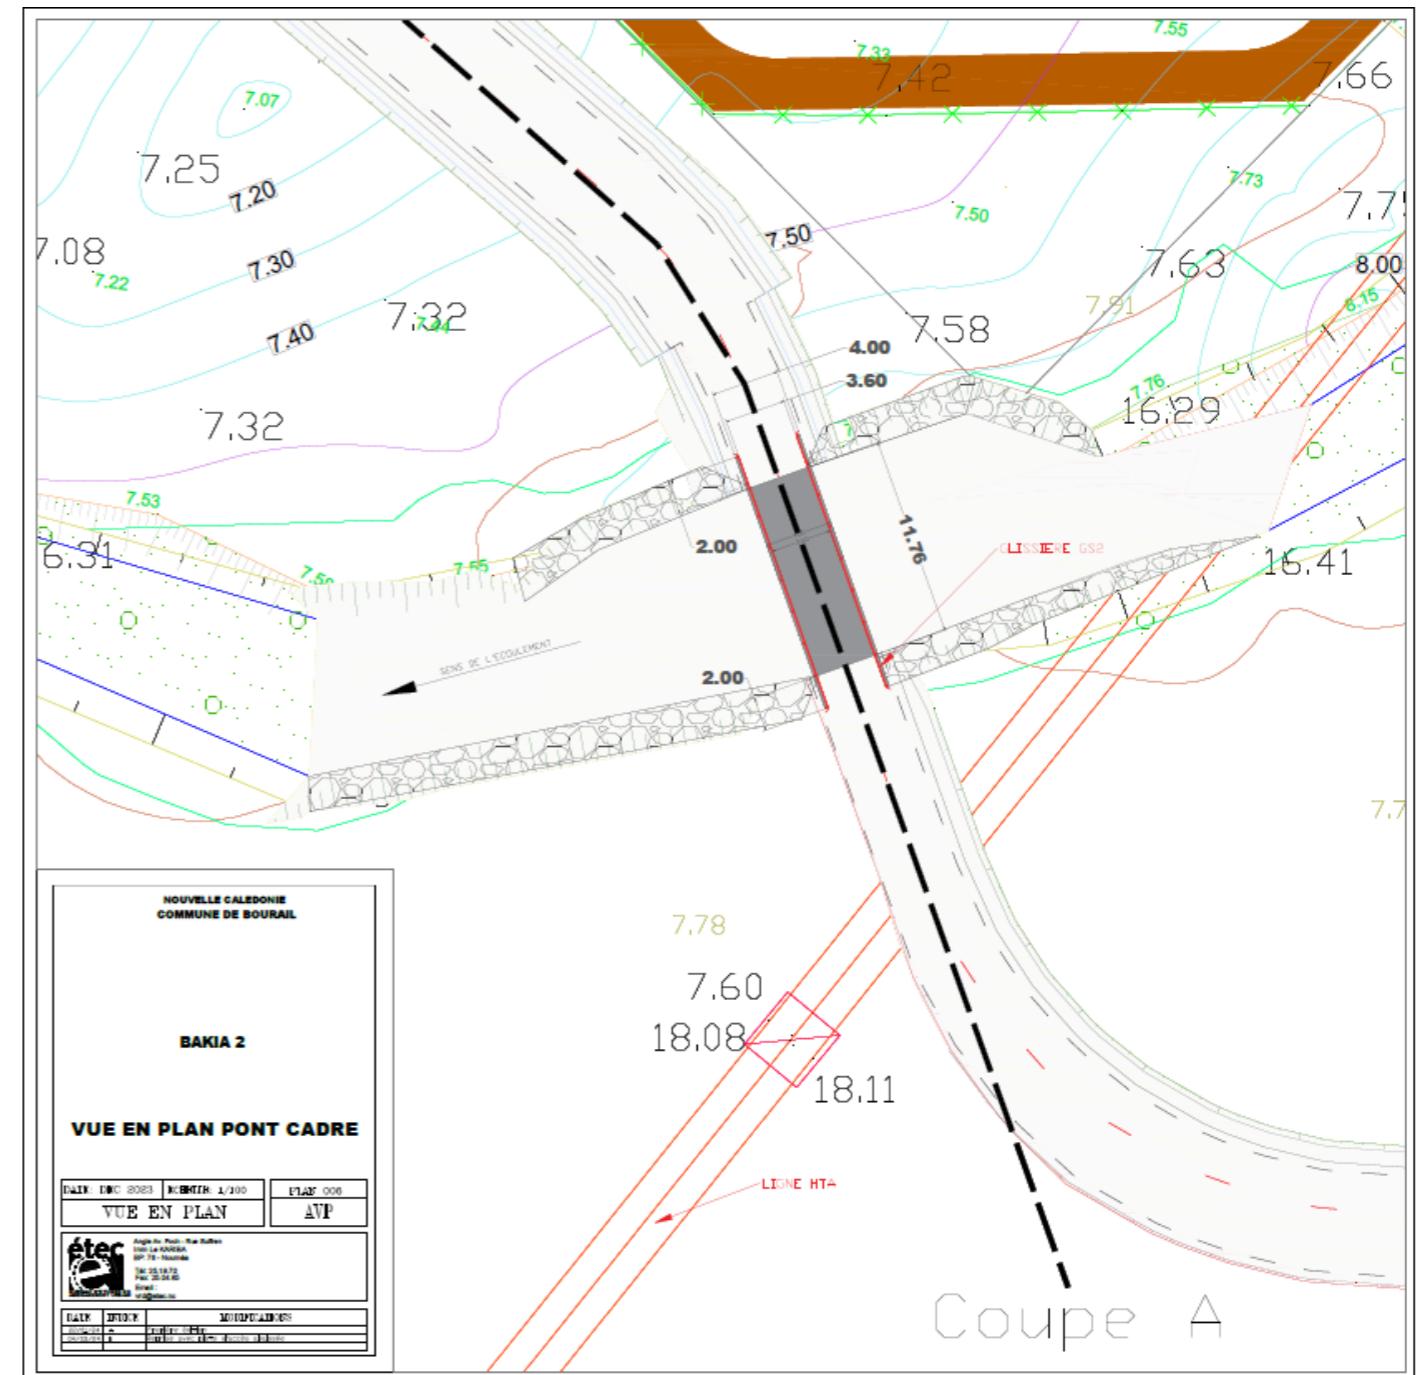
Vue en plan du pont cadre à créer pour l'accès au site d'implantation (source : éTEC)
